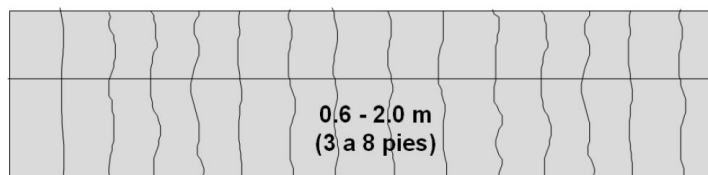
Pavimento de concreto armado con placas transversales. Fuente: M. Becerra Salas, Tópicos de Pavimentos de Concreto, Lima-Perú: Flujo libre, 2012
